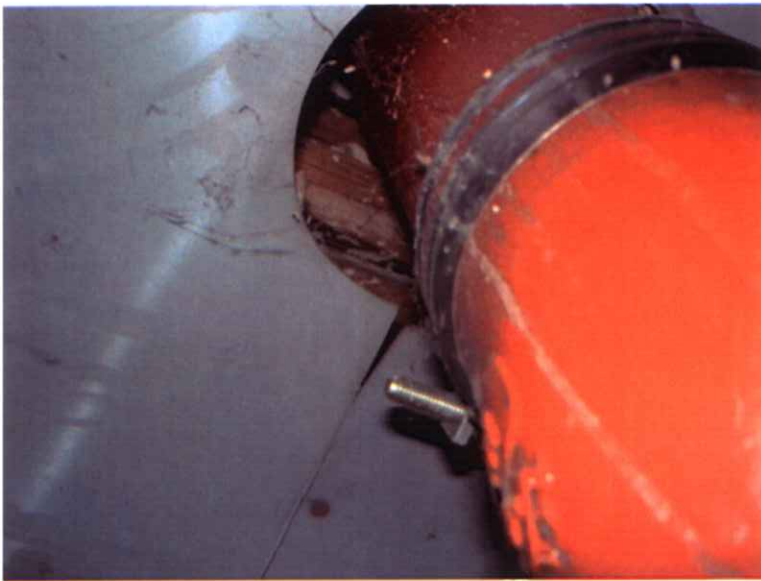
direkte adgang til trædæk ved gennemføring af faldstamme. Dette er ikke brandsikkert.
